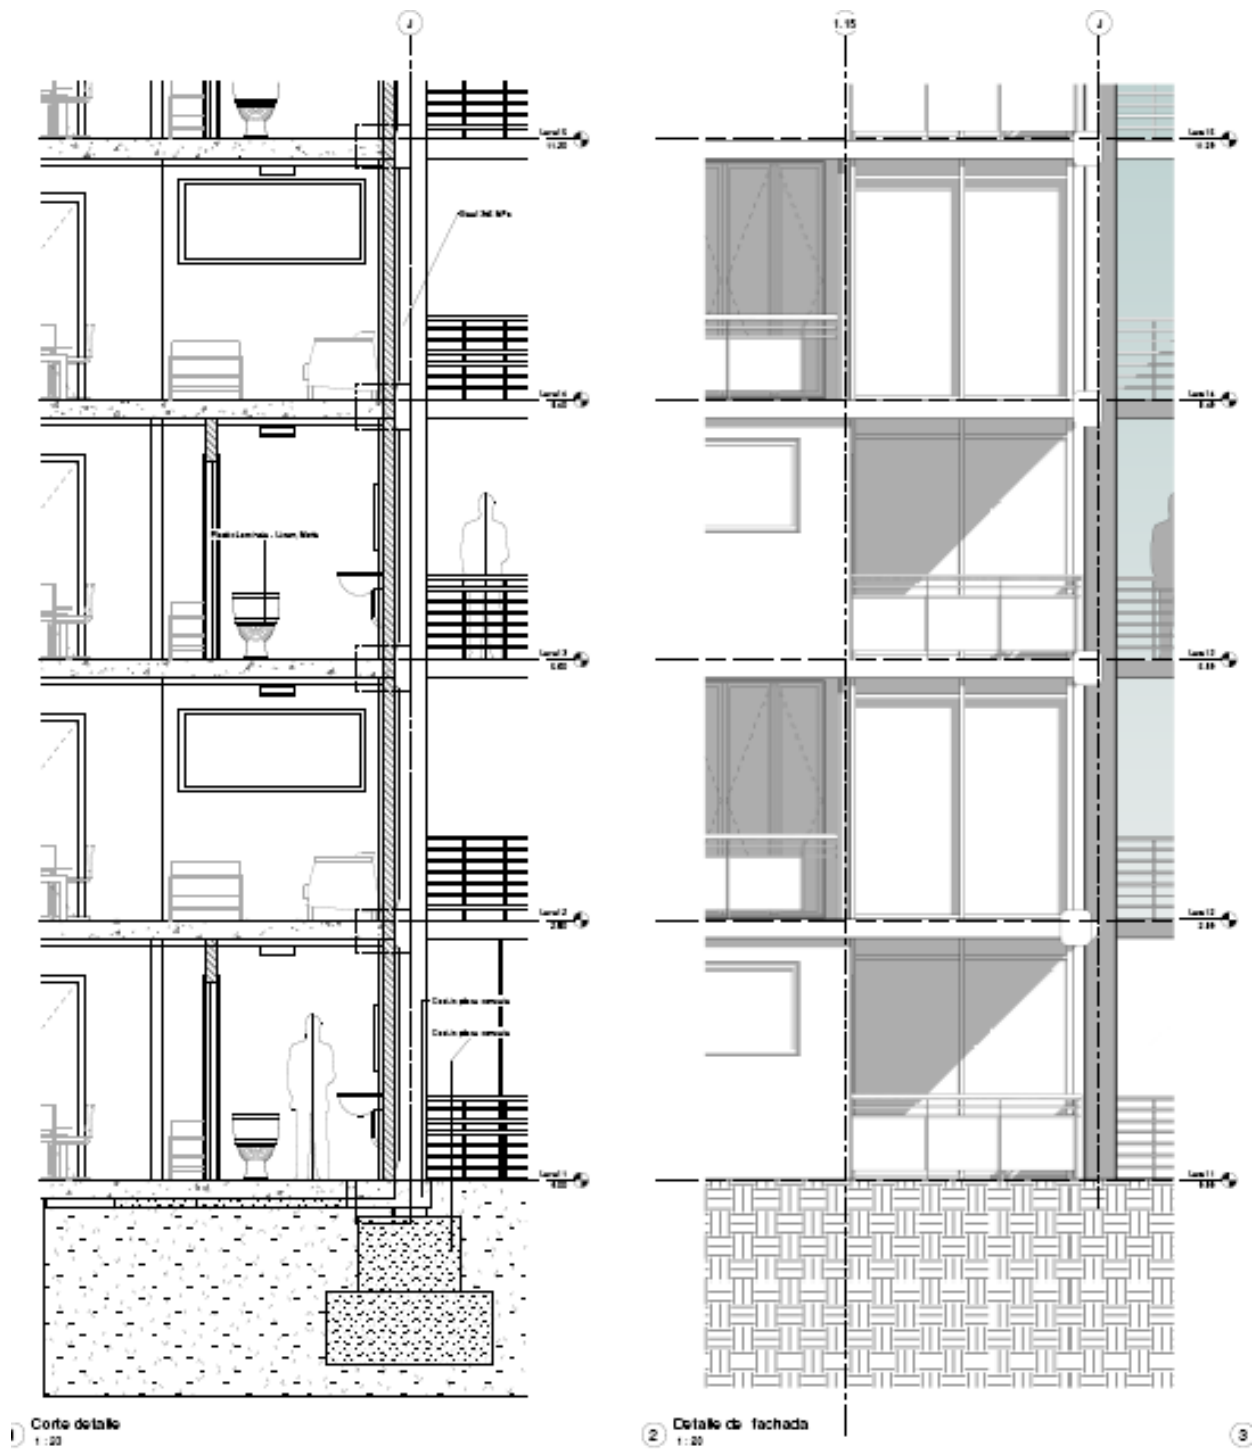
Anexo de corte y fachada de una sección del volumen 1 del proyecto - fuente propia.
